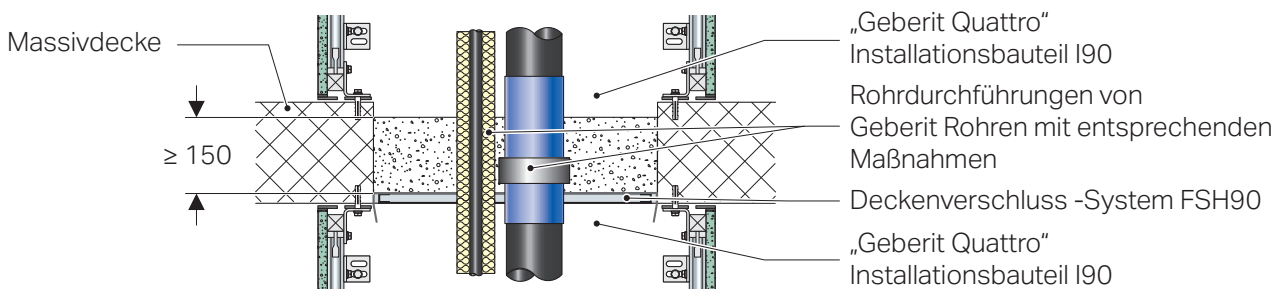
Deckenverschluss-System FSH90 in einem Geberit Quattro I 90-Installationsschacht mit Massivdecke
